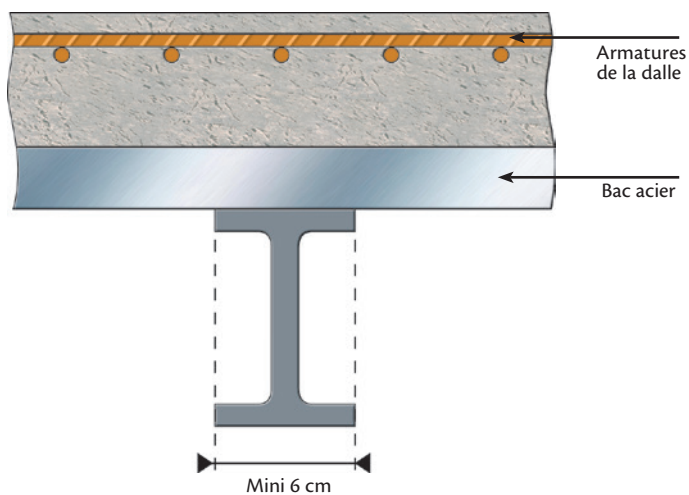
Appui de franchissement sur poutre ou solive métallique
